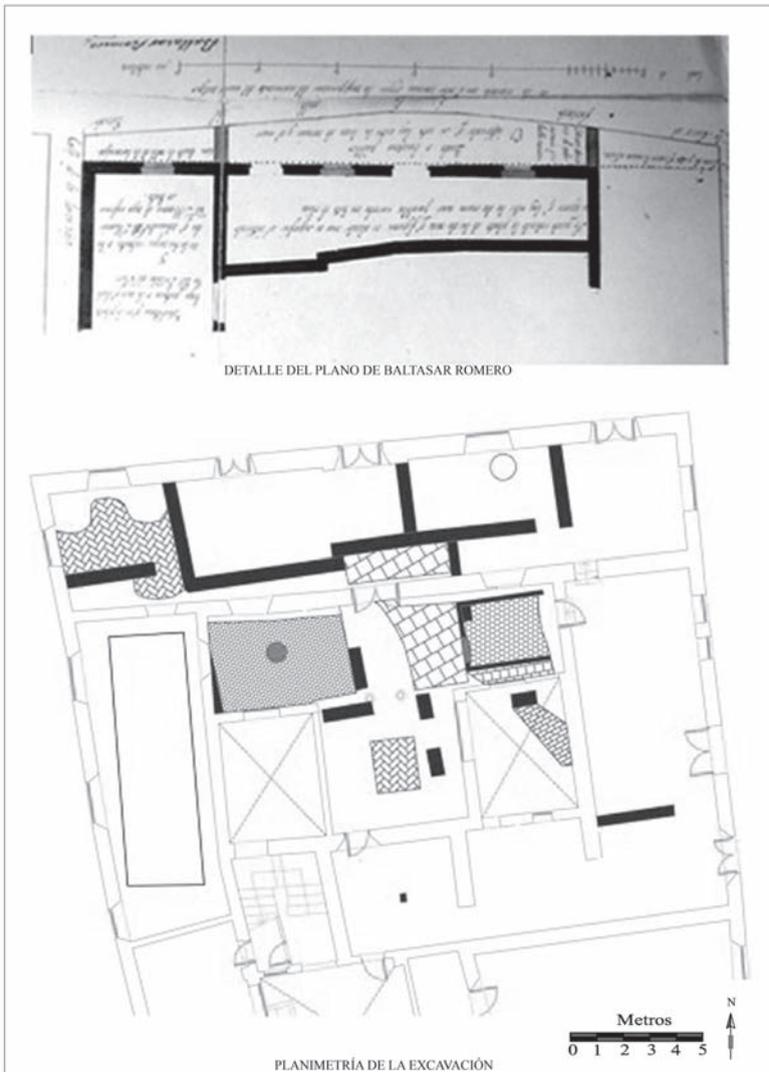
Comparación del Plano de Baltasar Romero (1856) con la planta de los restos del siglo XIX hallados en la excavación
